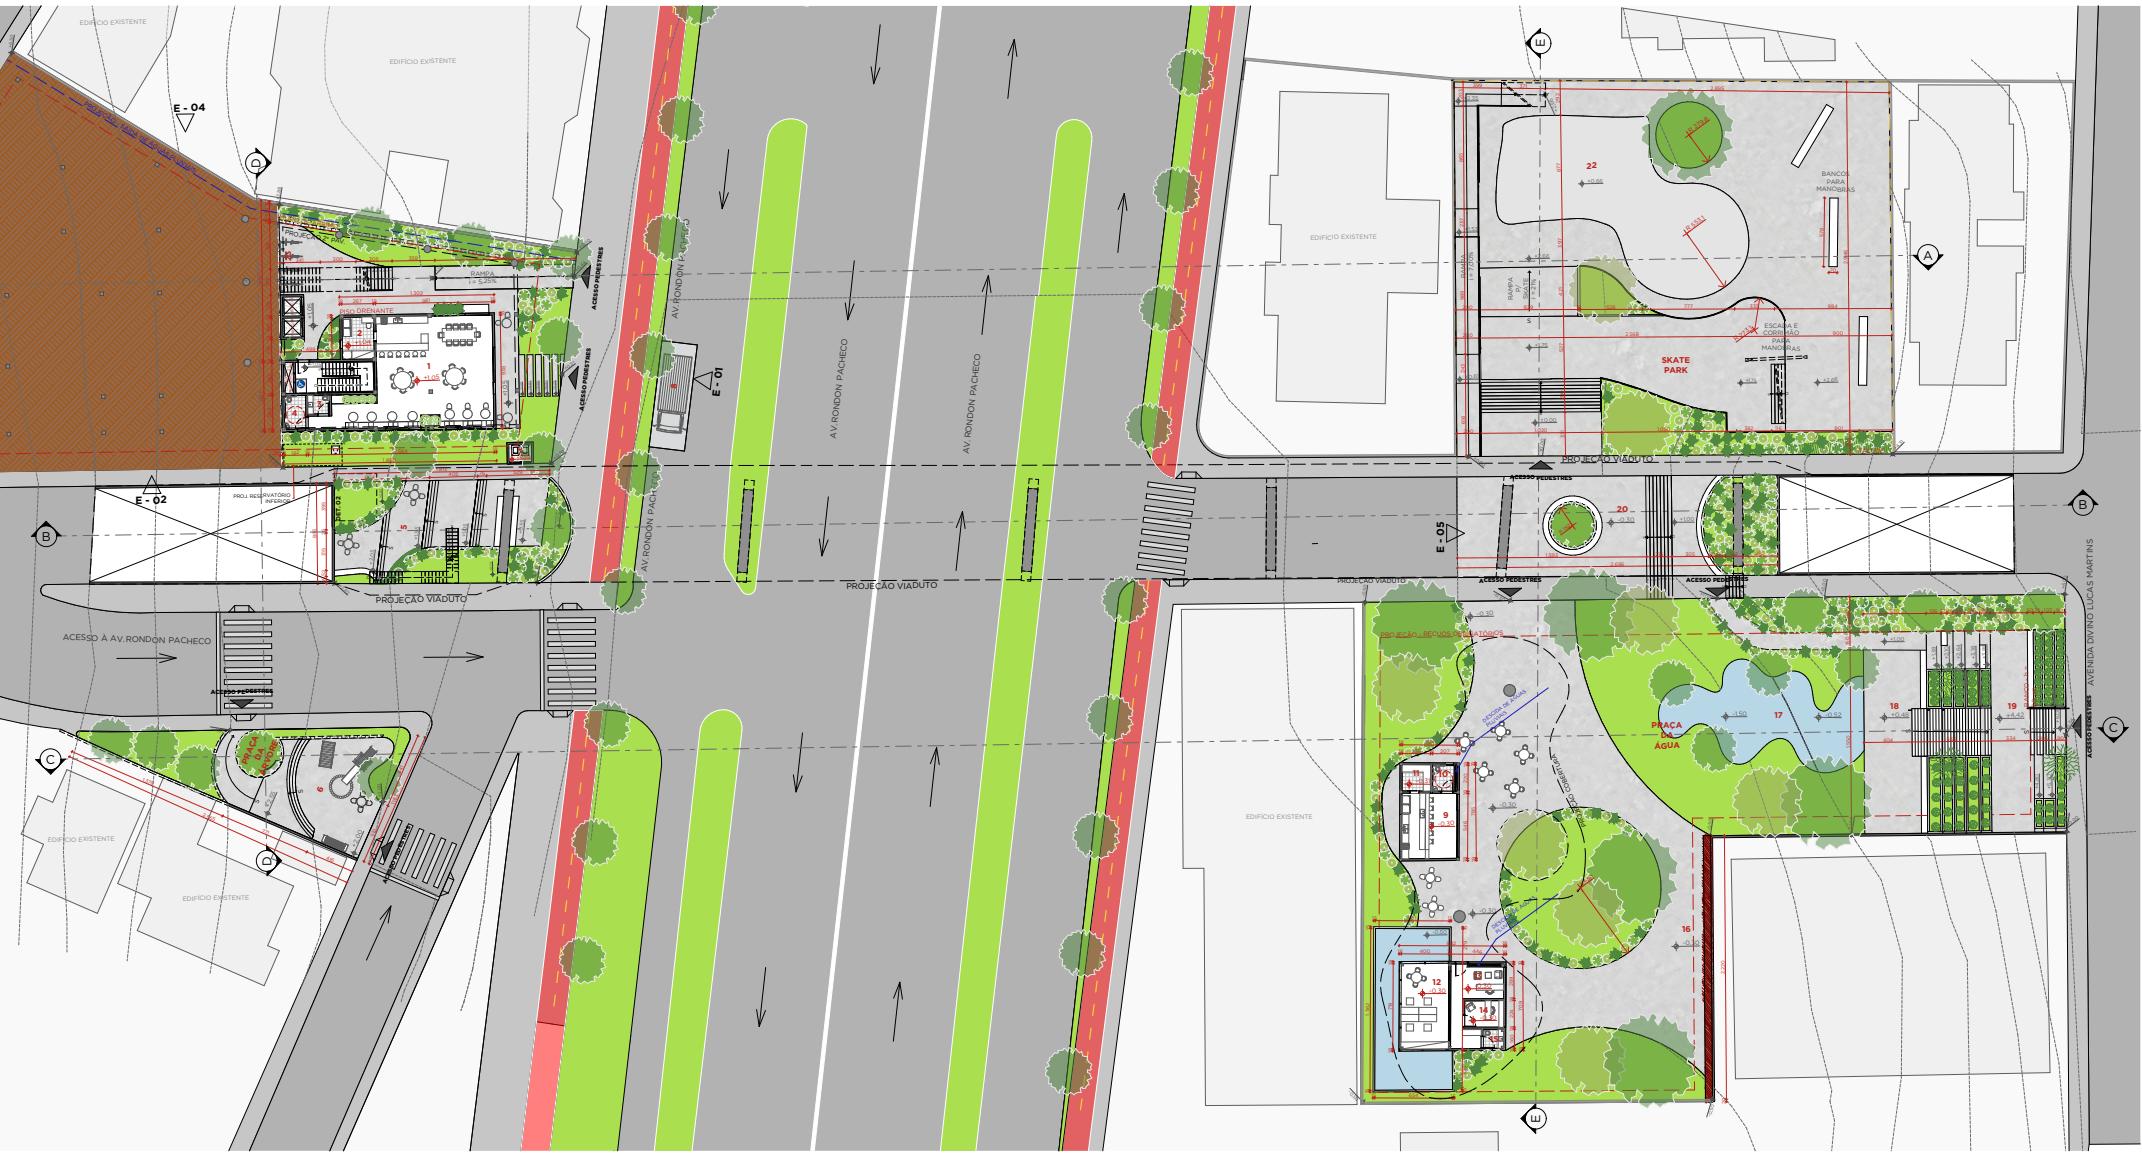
Planta de Implantação (térreo 01 - nível +1) - sem escala.
